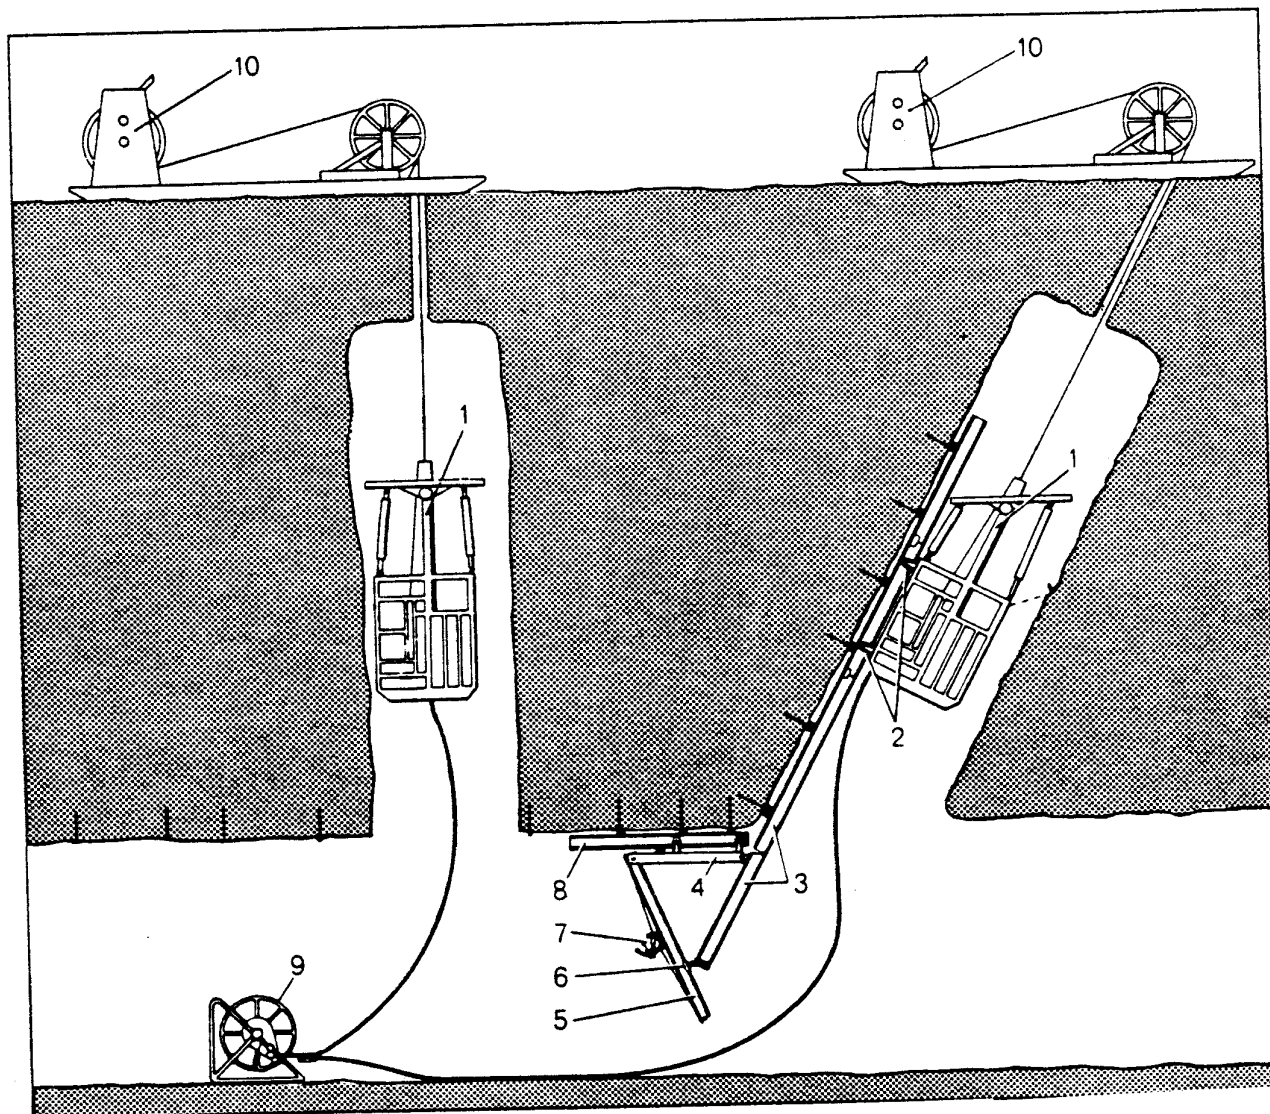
Principales componentes de la Jaula Jora
